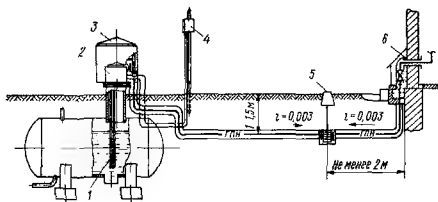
Схема газоснабжения сжиженным газом от групповой резервуарной установки с регазификаторами.
